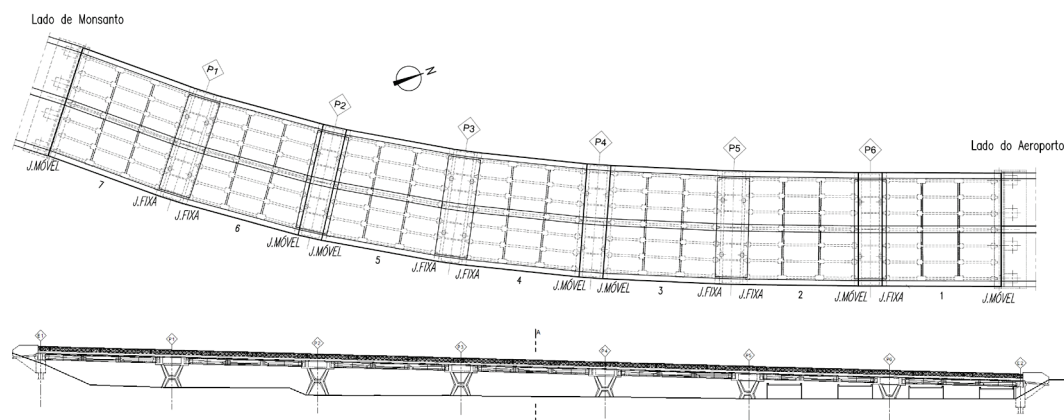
Dimensionamento geral e vista da face inferior do tabuleiro
